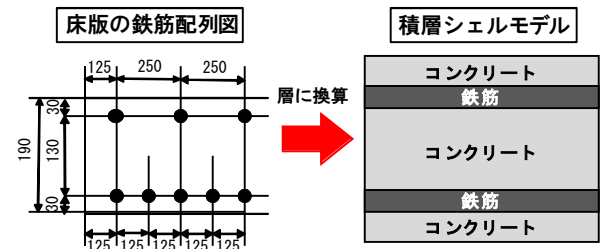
積層シェル要素のモデル化の一例 (単位 : mm)
